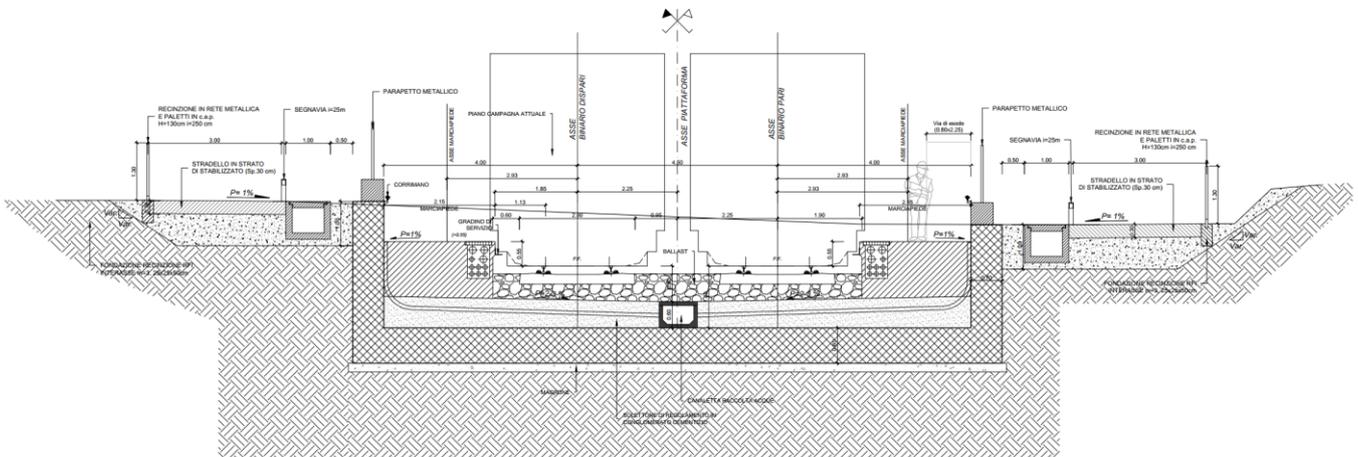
Sezione tipo con muro ad U (tipo U1) a doppio binario
